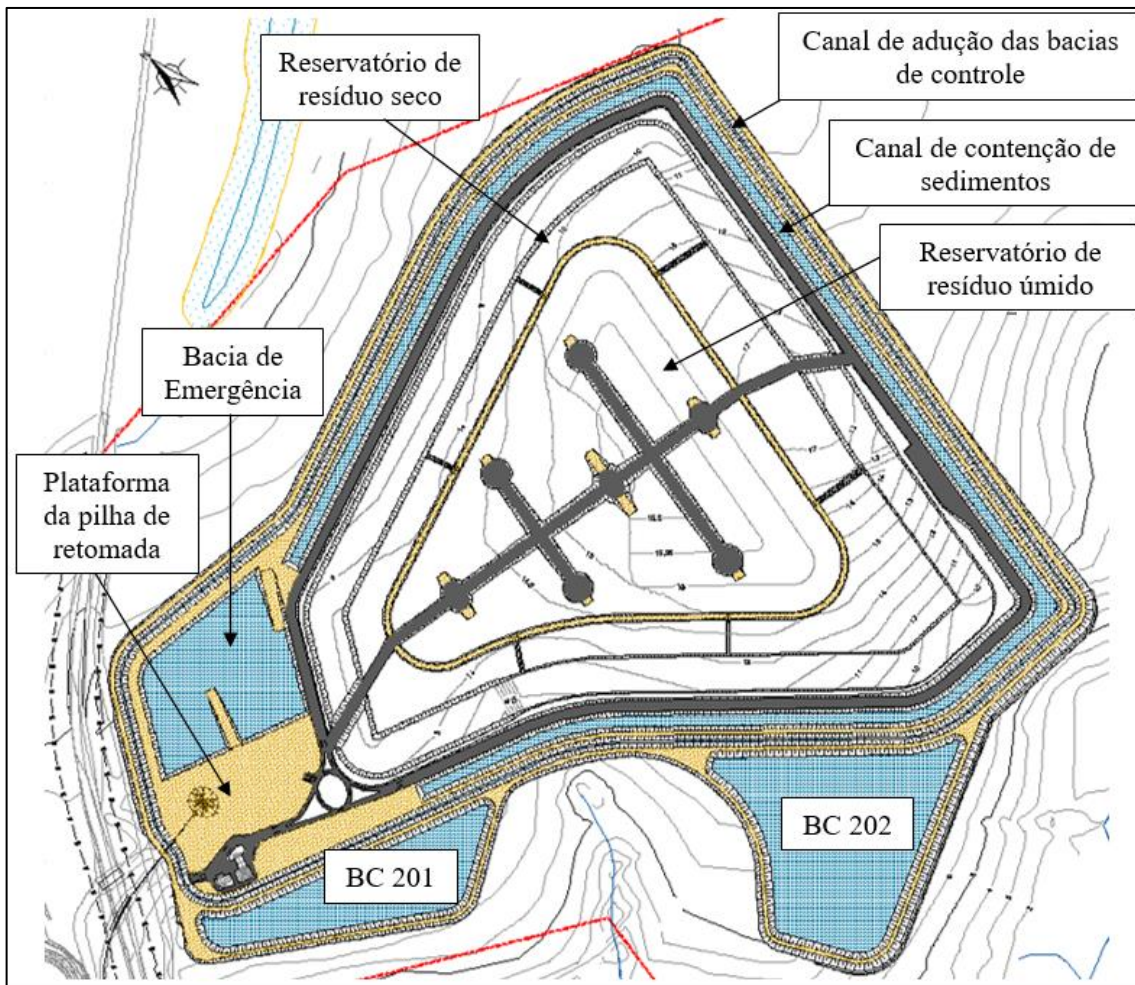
Layout da fase 1 do DRS2 (MD-3541-54-G-096)
